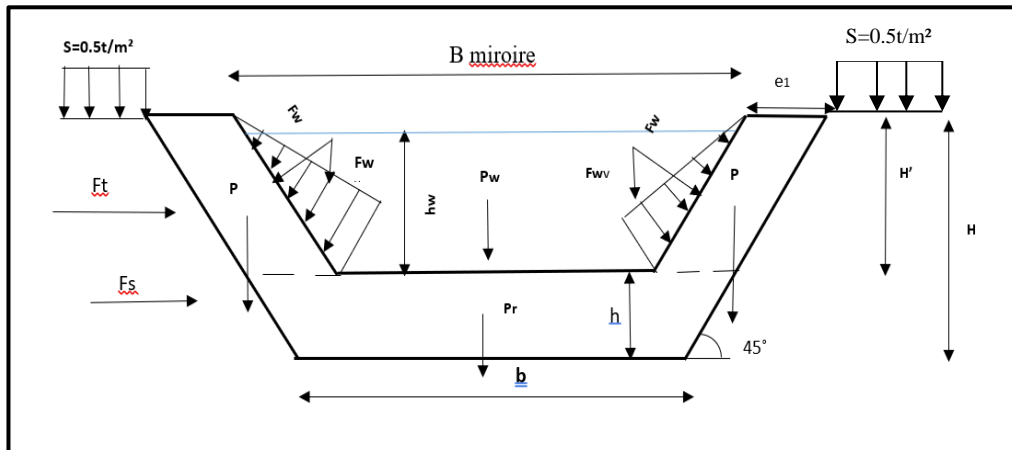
schéma des forces agissant sur la stabilité du canal trapézoïdal d'oued Hamou
